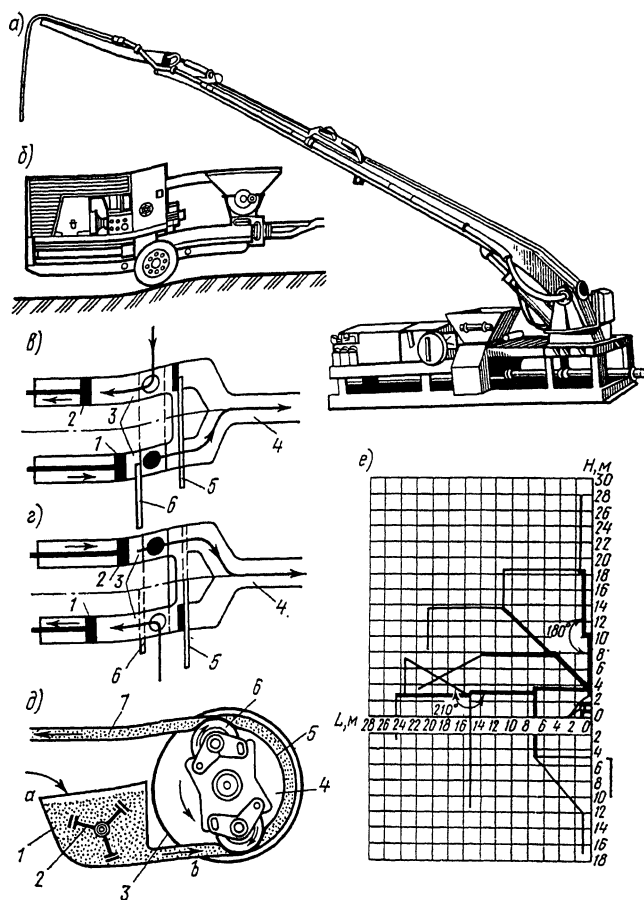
Транспортировка бетонной смеси с помощью передвижных бетононасосов (прицепных и автобетононасосов)
